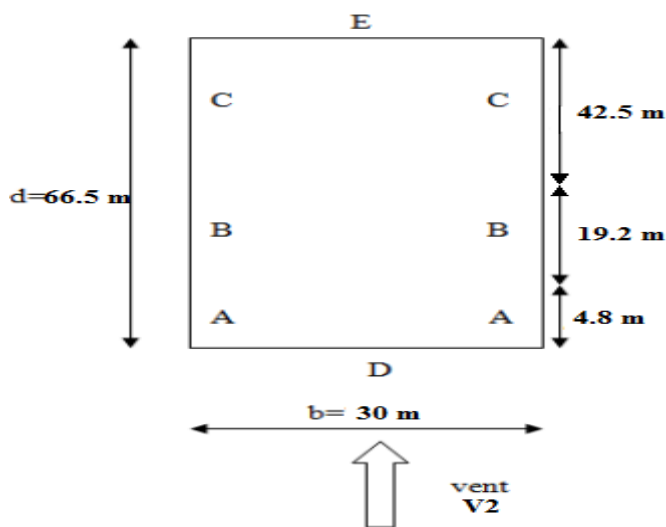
Vue en plan des zones de pression sur les parois verticales suivant le pignon
